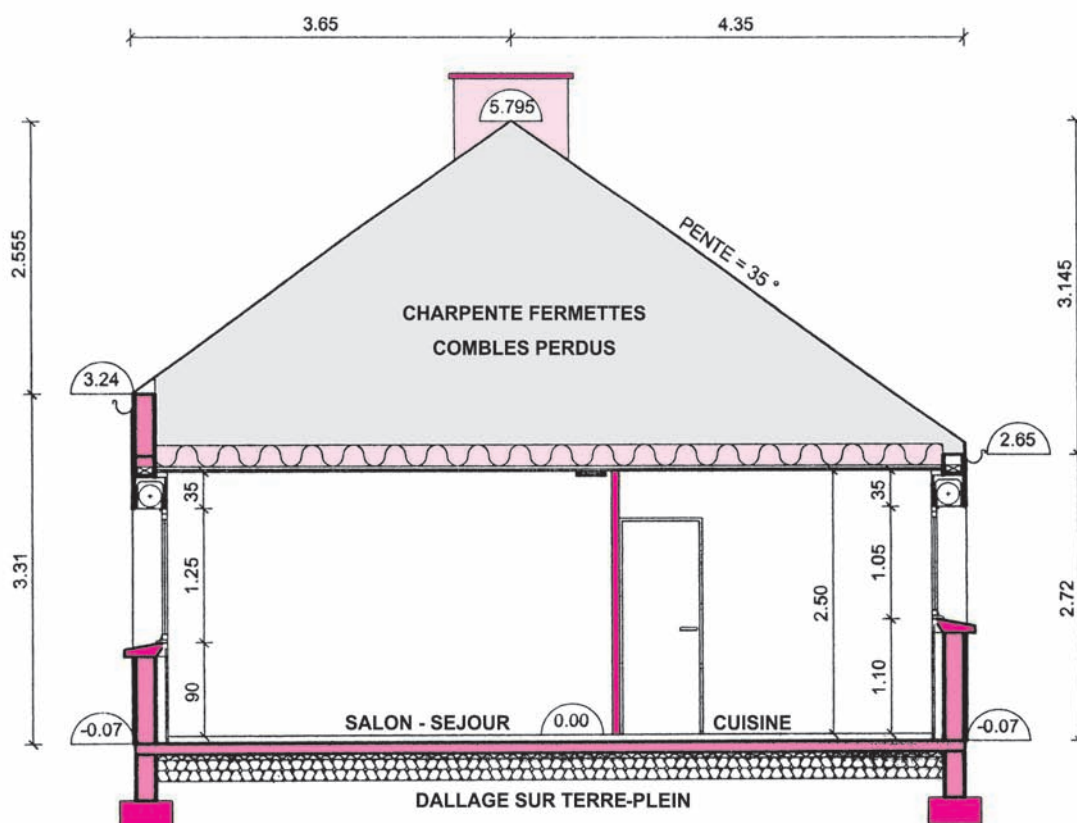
Coupe suivant les repères BB → Coupe BB
